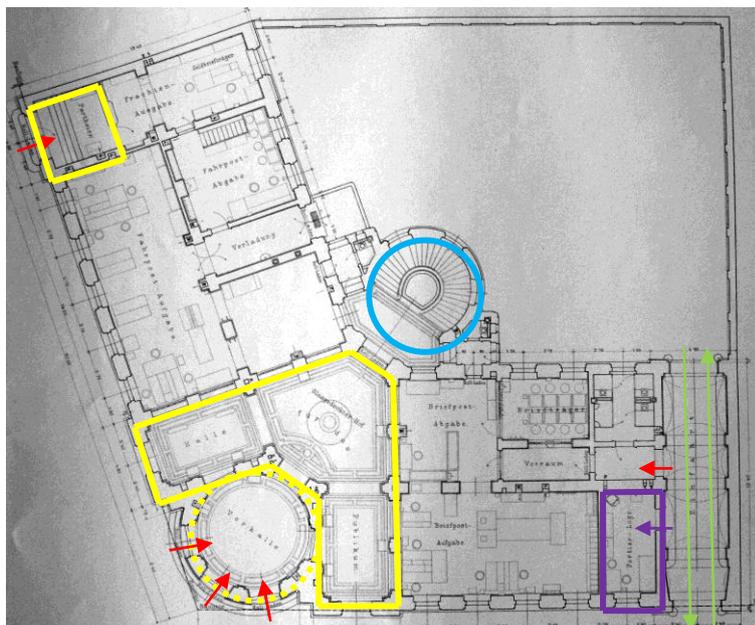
Erdgeschoss des Postgebäudes in Bozen [gelb: strichliert: Vorhalle; Schalterhalle und Parteienraum/ lila: Portiersloge (keine Wohnung, sondern nur ein Aufenthaltsraum (mit eigenem Zugang über die Durchfahrt)/ blau: einziges Treppenhaus (Monumentaltreppe = Erschließung des ganzen Gebäudes, vom Keller bis in das 2. Obergeschoss)/ rote Pfeile: Eingänge in das Gebäude/ grüne Pfeile: Ein- und Ausfahrt in den Posthof]
